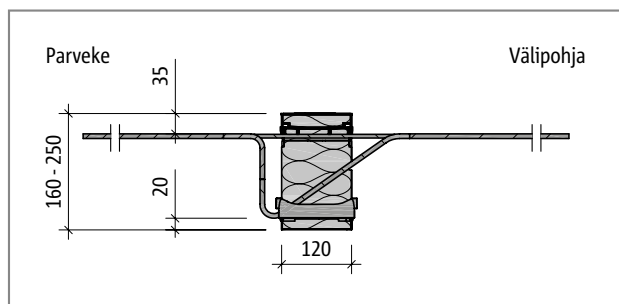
Schöck Isokorb® KXT-E: Kouru, detaili B
